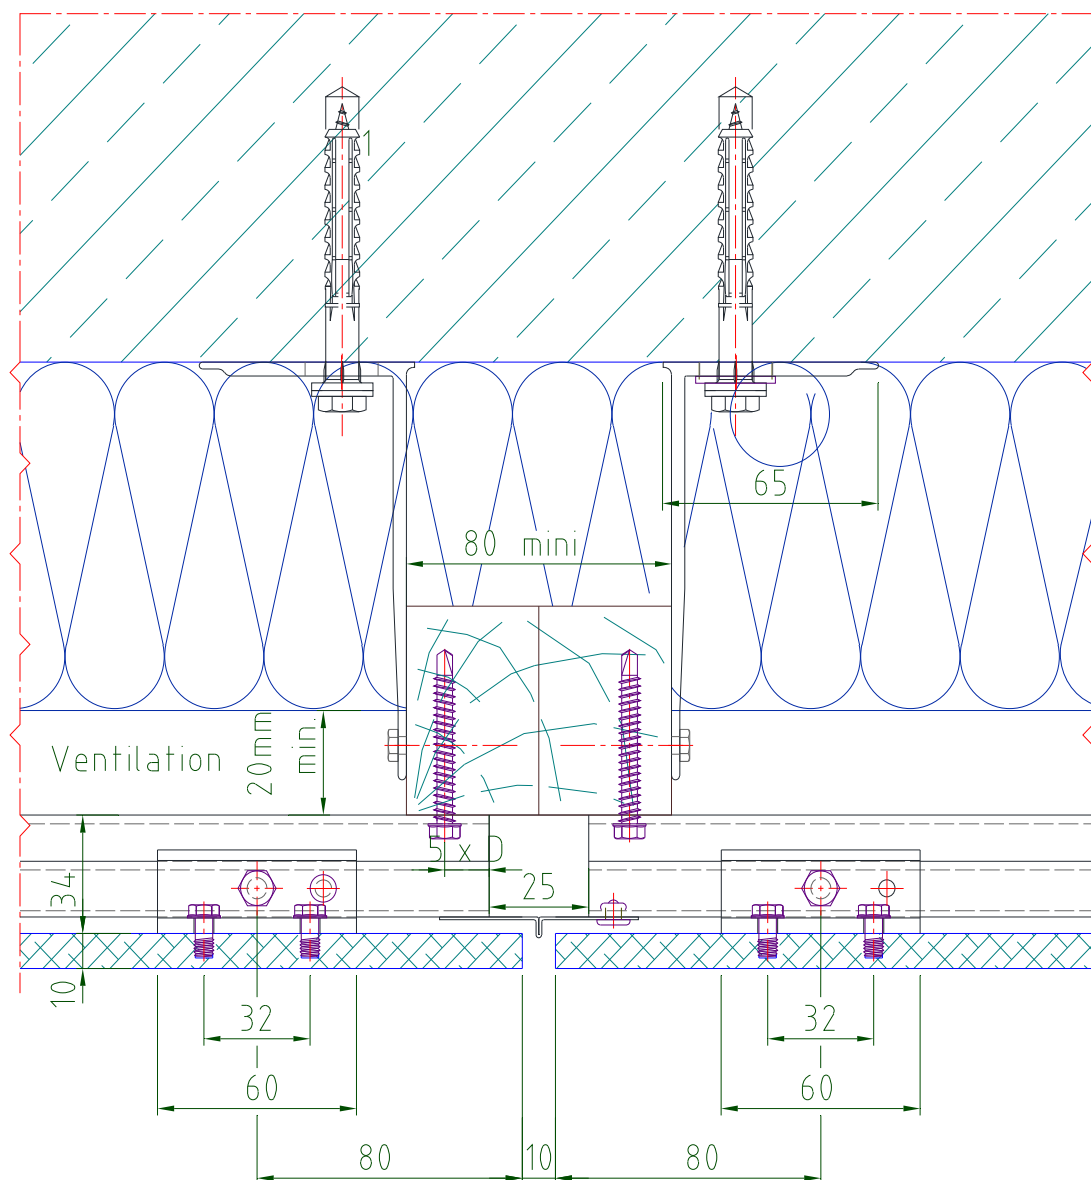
Détail jonction de rails horizontaux à joints fermés
